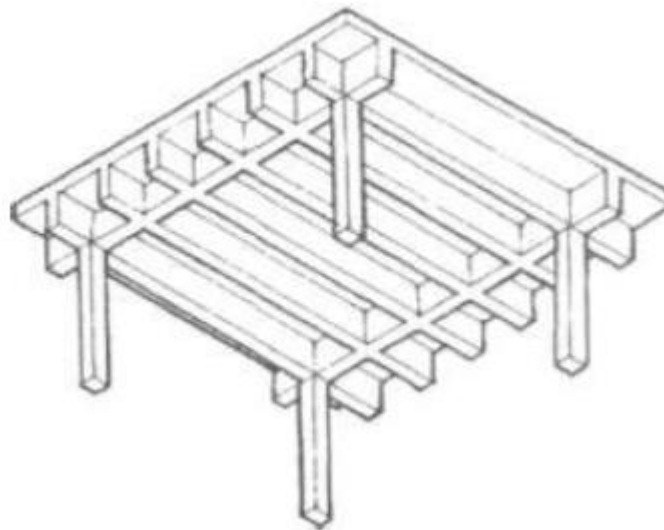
Viguetas de Concreto en una dirección. Fuente: (MOORE, 2000, pág. 99)
